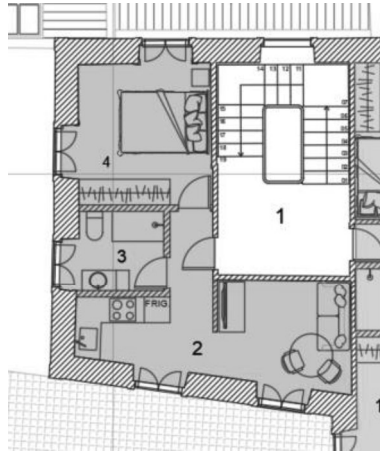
Planta do apartamento número 5 do piso 0 | Beatriz Figueiredo
